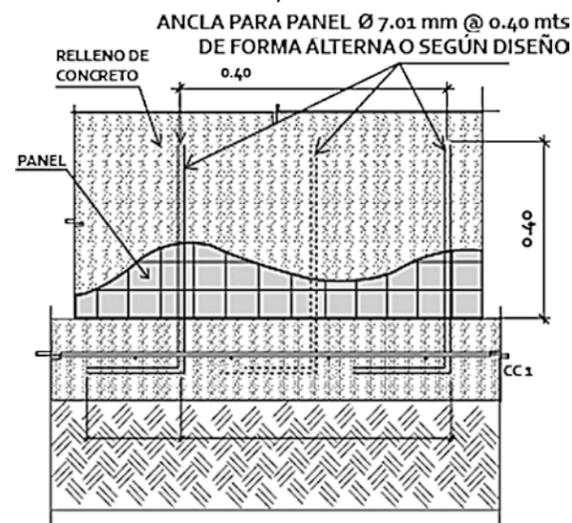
Detalle de anclaje panel con cimientto. Varillas colocadas al colado.
